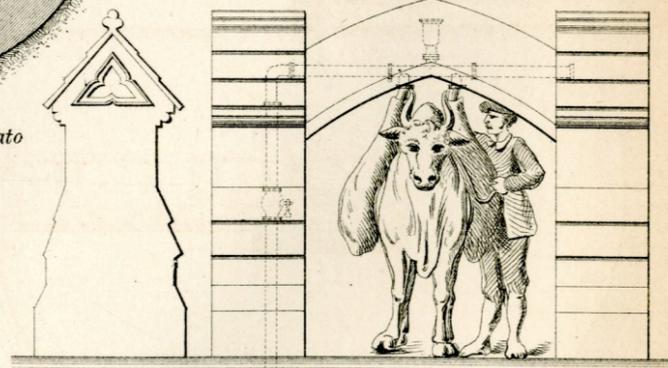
e 16. Fianco ed elevazione. - 1 a 50.
